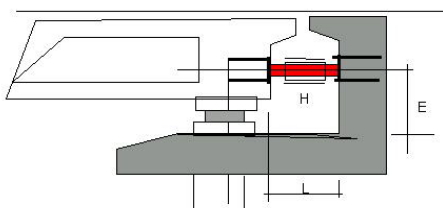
Dispositif amortisseur placé entre le tablier et la culée / Damping device positioned between the deck and the abutment
